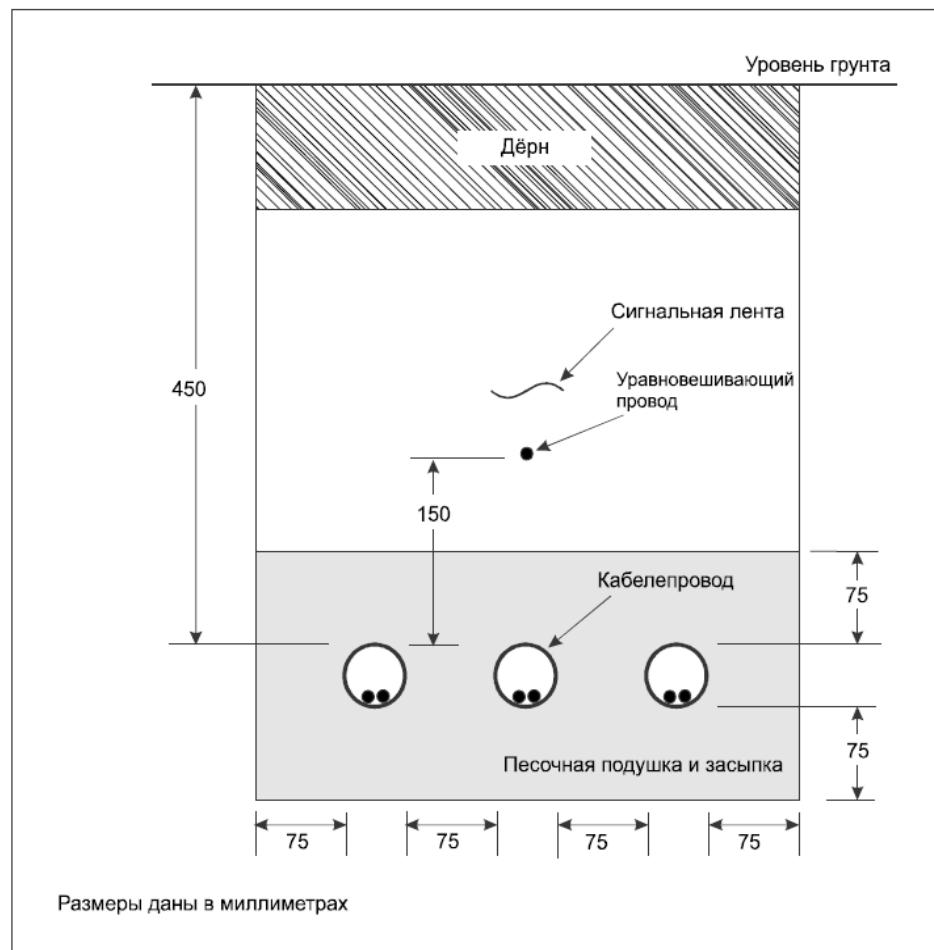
Кабельный канал/кабелепровод без бетонной облицовки
